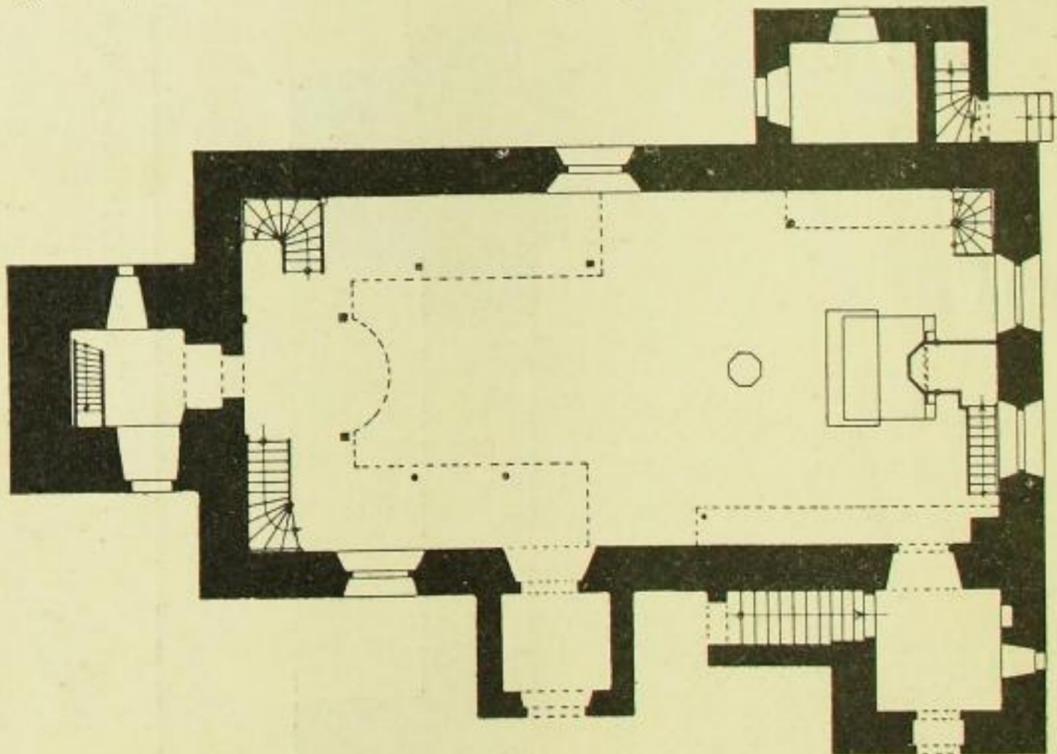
Kleinbautzen, Kirche, Grundriß.
